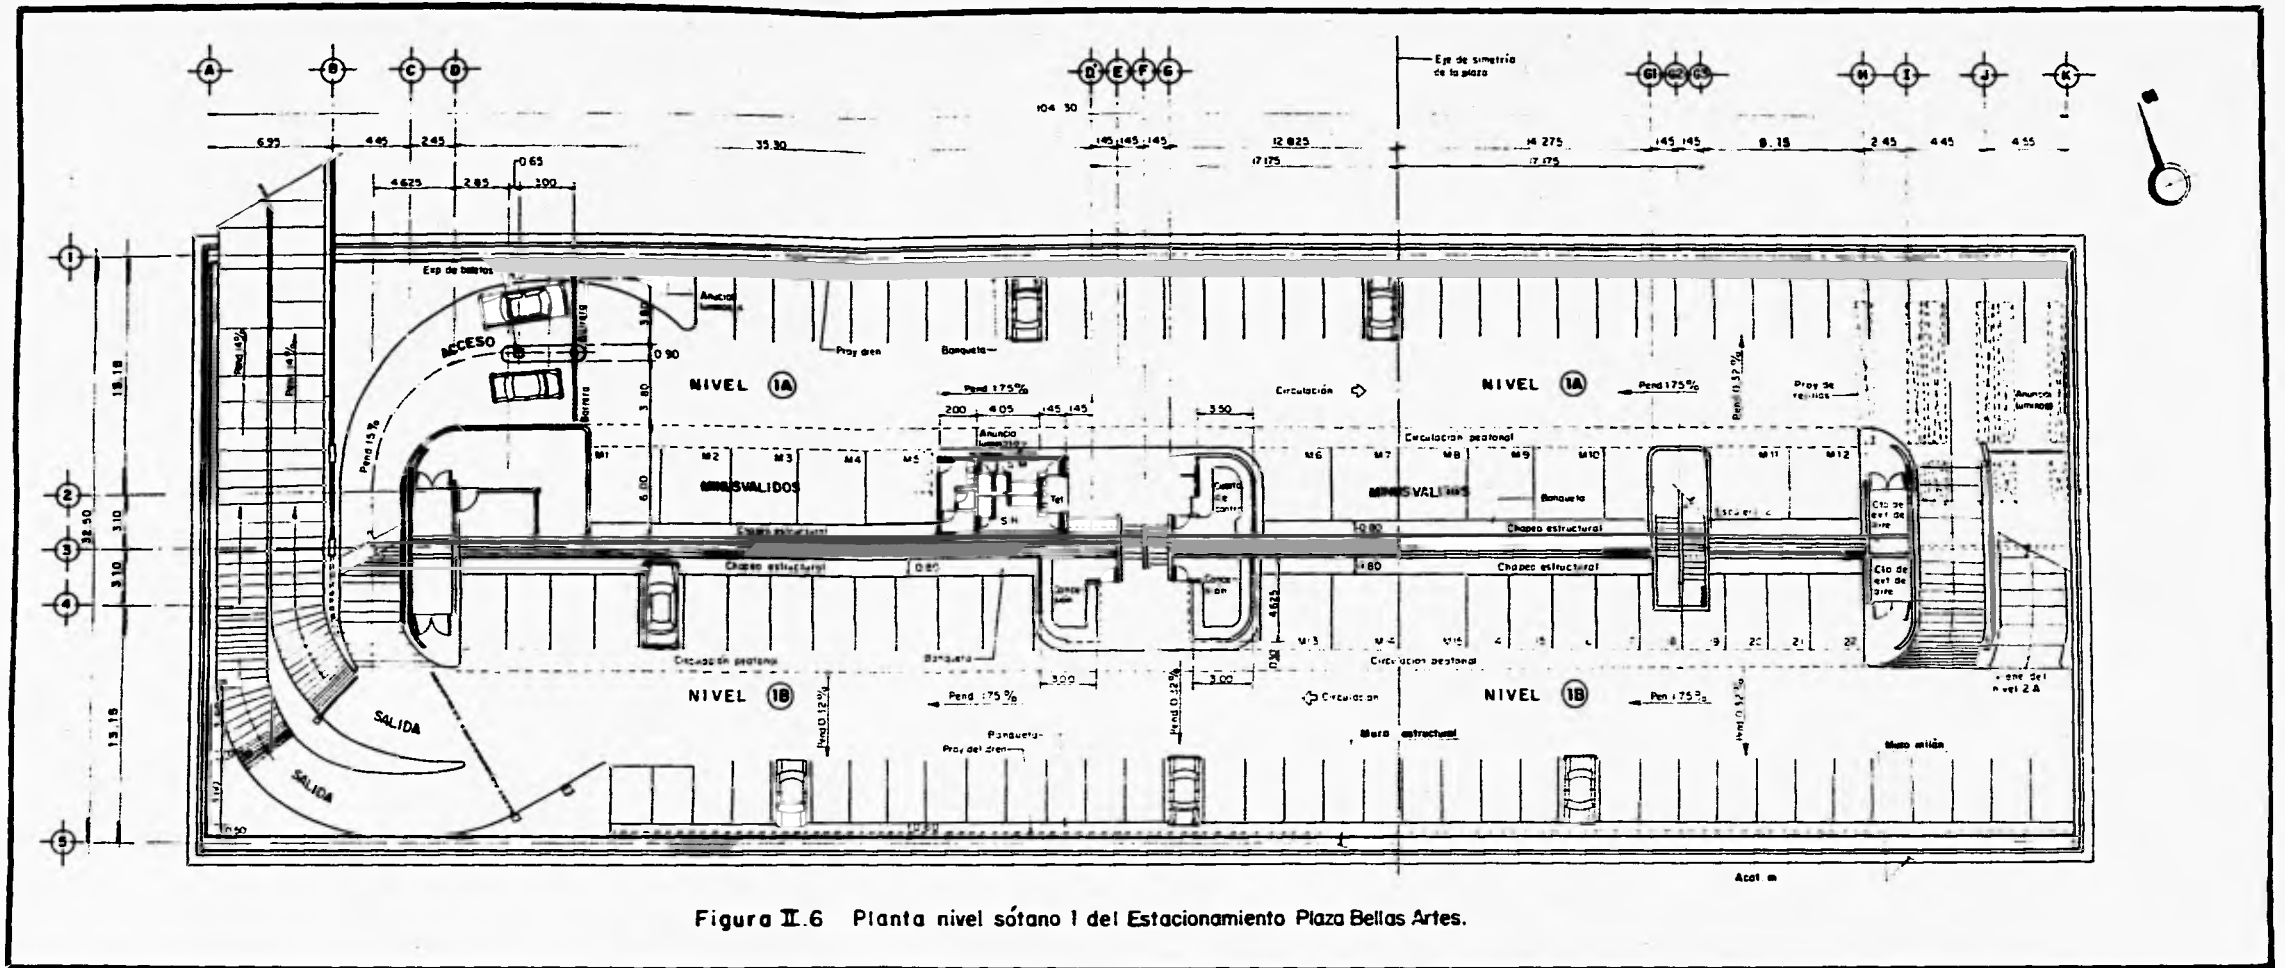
Planta nivel sótano I del Estacionamiento Plaza Bellas Artes.
